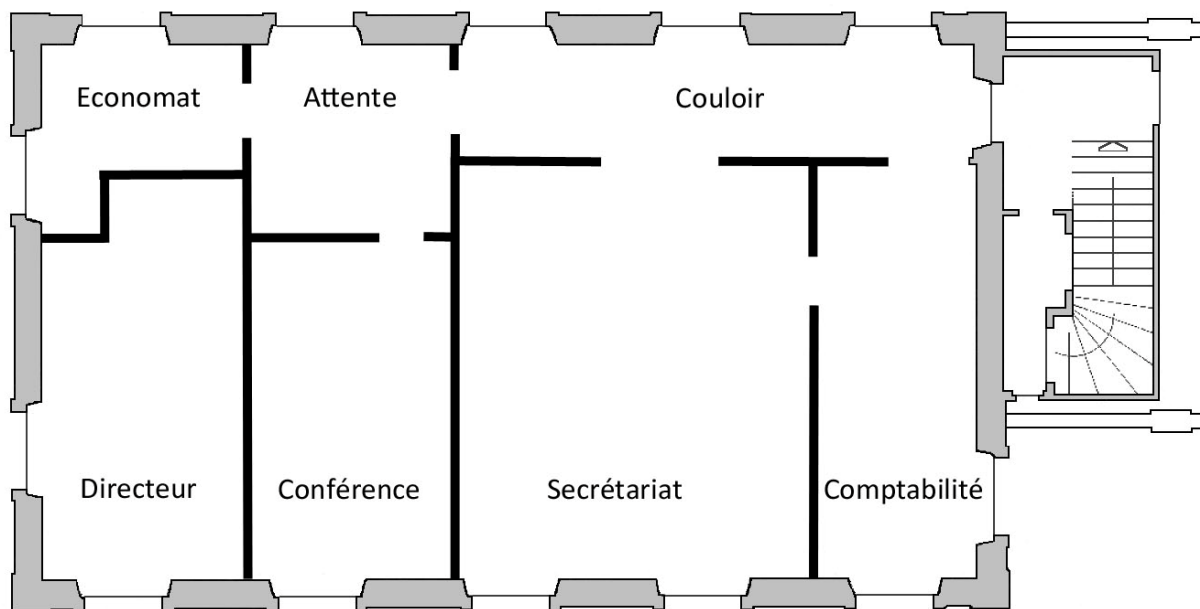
Collège de la Promenade, plan du 1^{er} étage aile ouest.
